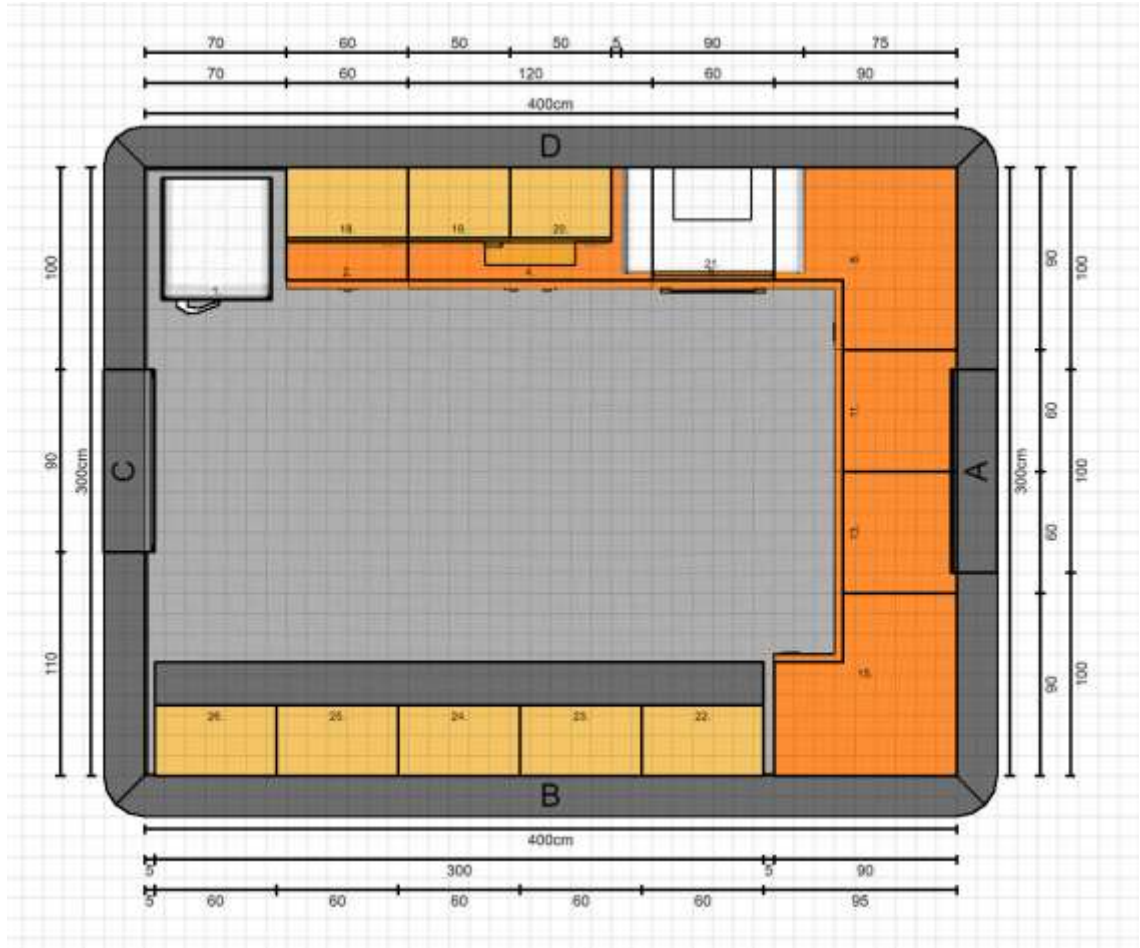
Planta baixa – cozinha tipo 'Dark Kitchen'.
